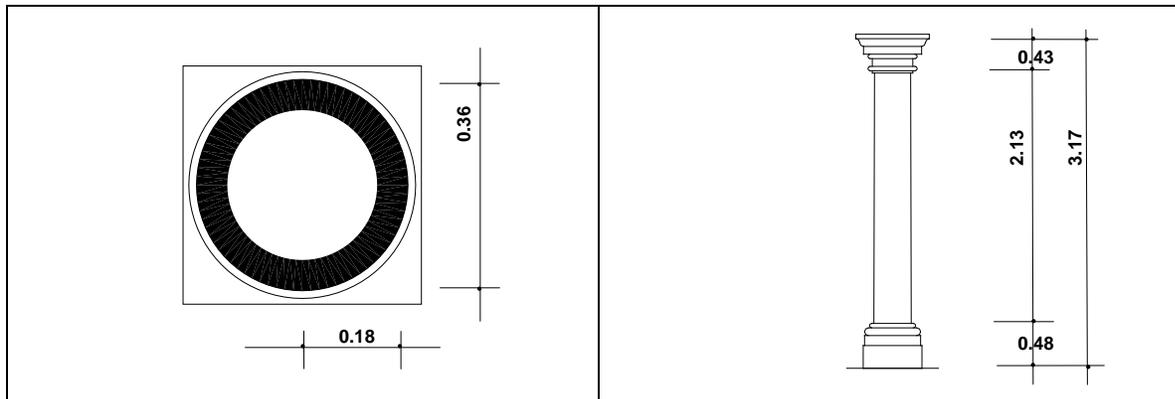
Diámetro y radio a la altura del imoscapo de columnas en planta alta, casa de Isidro Huarte.
